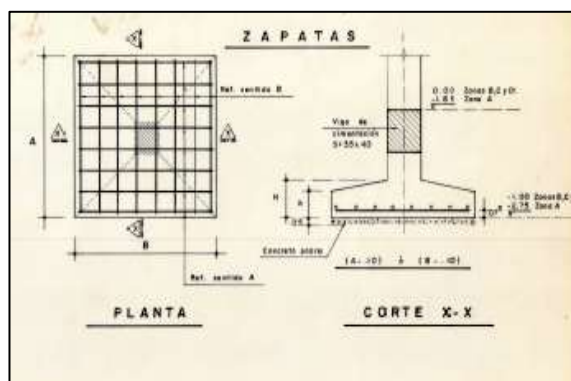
Fuente: autores, (2018). Cimentación del edificio según plano estructural, planos originales alcaldía por Ing. Carlos Navas Camargo.
